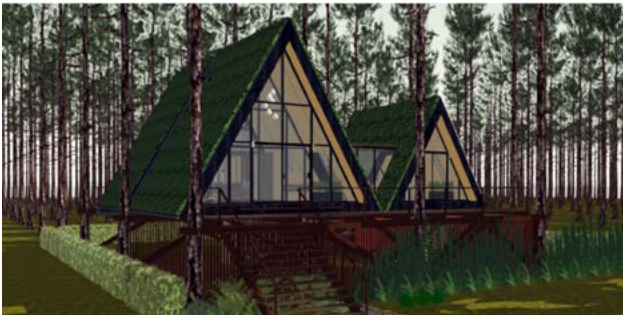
Vista, acceso vivienda /// Fuente: Elaboración propia
